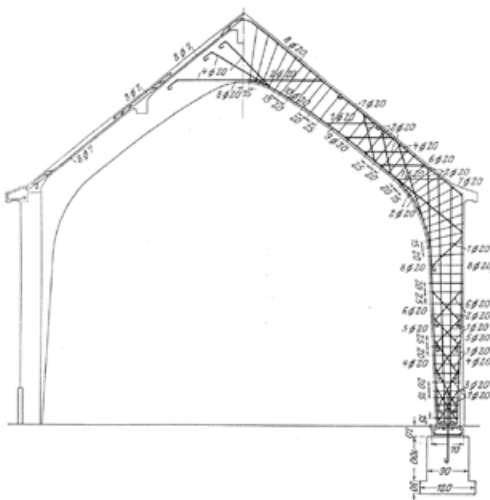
Bewehrungsplan (Emperger 1915, S. 79).
